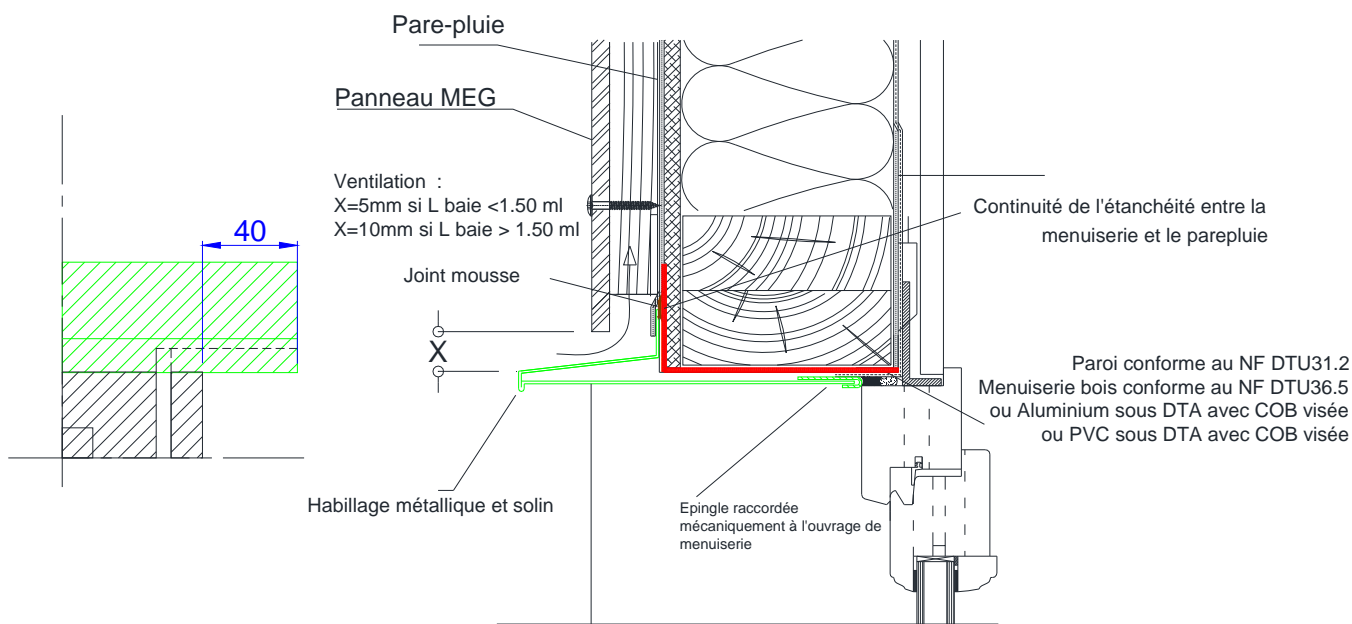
Pose sur COB -Coupe sur linteau de baie
